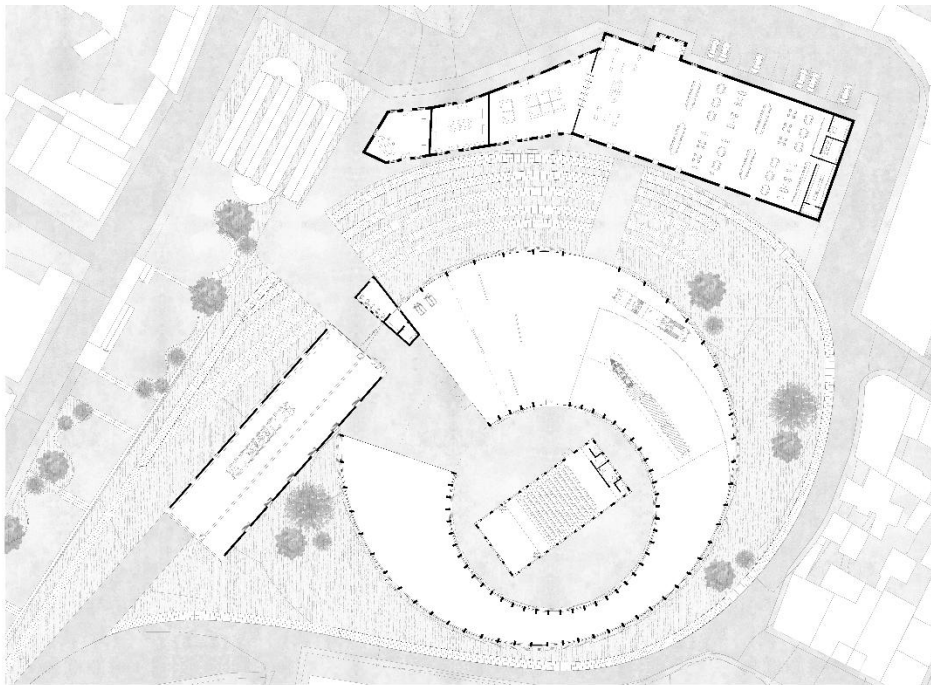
Planta Baja ± 0.00 . Elaboración propia.
